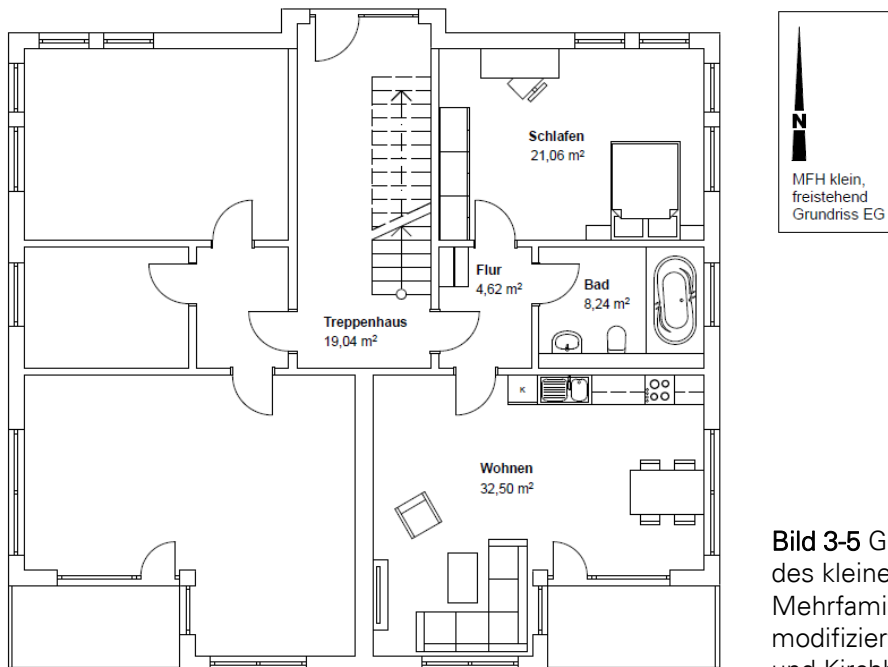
Grundriss Erdgeschoss des kleinen freistehenden Mehrfamilienhauses, erstellt und modifiziert auf Basis von [Klauß und Kirchhof 2010].
